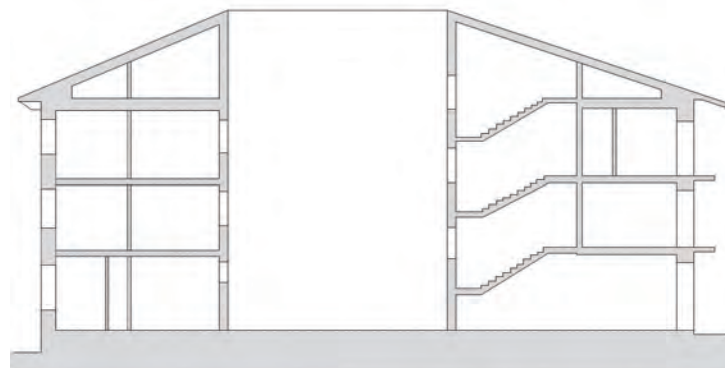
18. SECCIÓN LONGITUDINAL
